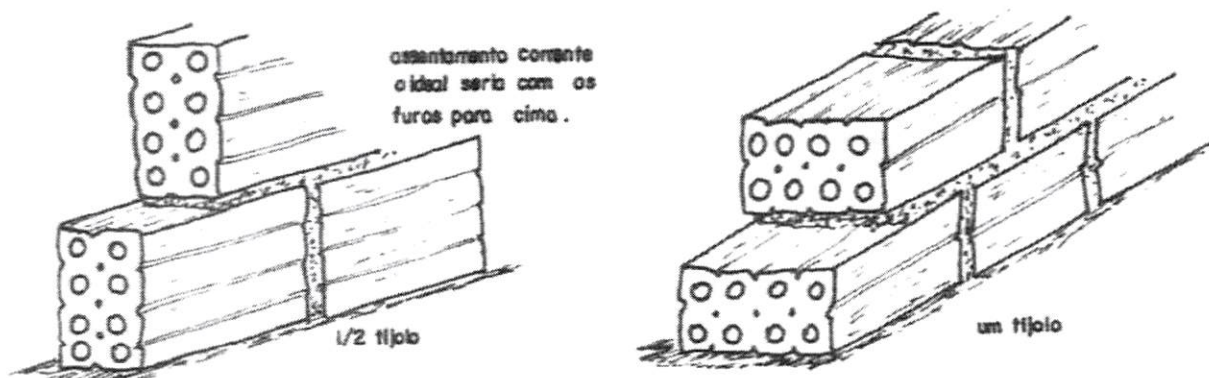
Execução de alvenaria utilizando tijolos furados.
